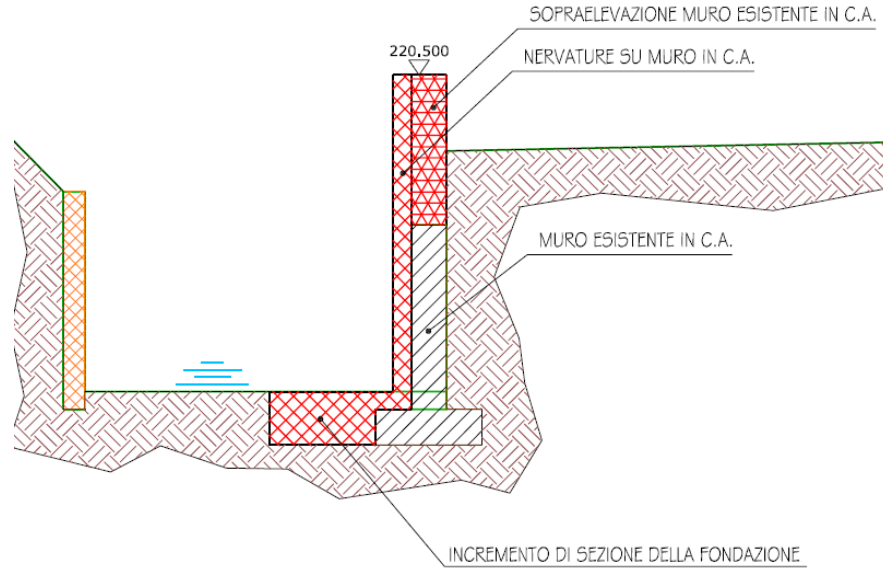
Consolidamento e sopraelevazione del muro esistente, tratto 2
